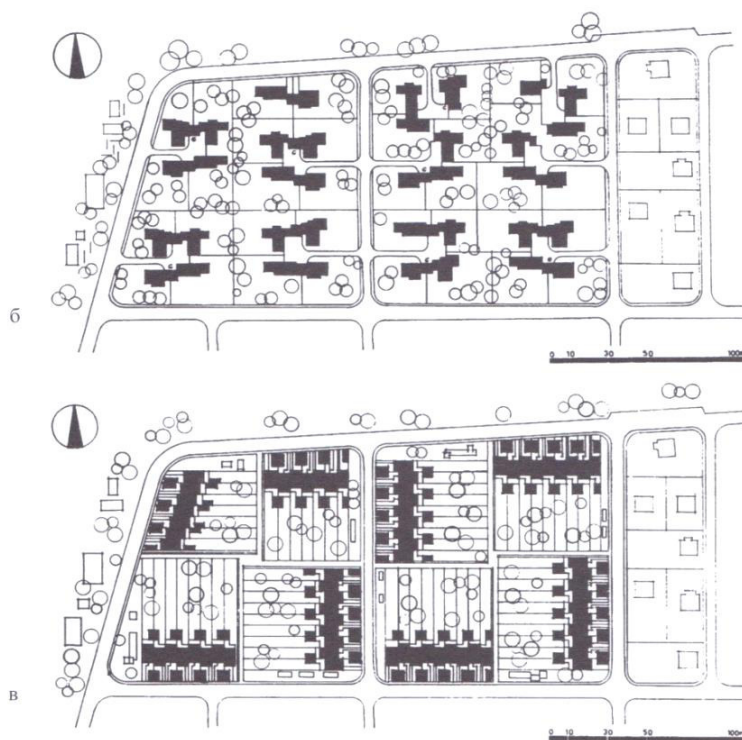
Схеми розташування садибних будинків: б – блоковані будинки («будинки-близнюки»), розташовані на межі двох ділянок; в – блоковані секційні будинки, що займають всю ширину ділянки (таунхауси) [2, С. 73]
